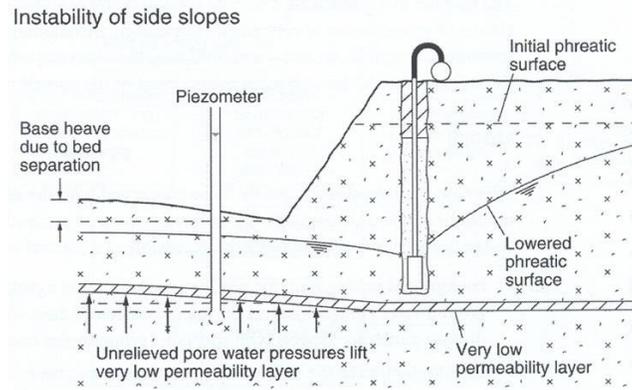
Levantamiento del fondo debido a la excavación en un suelo sobre un acuífero confinado, en recinto no delimitado por diafragma (PREENE et al., 2004).
